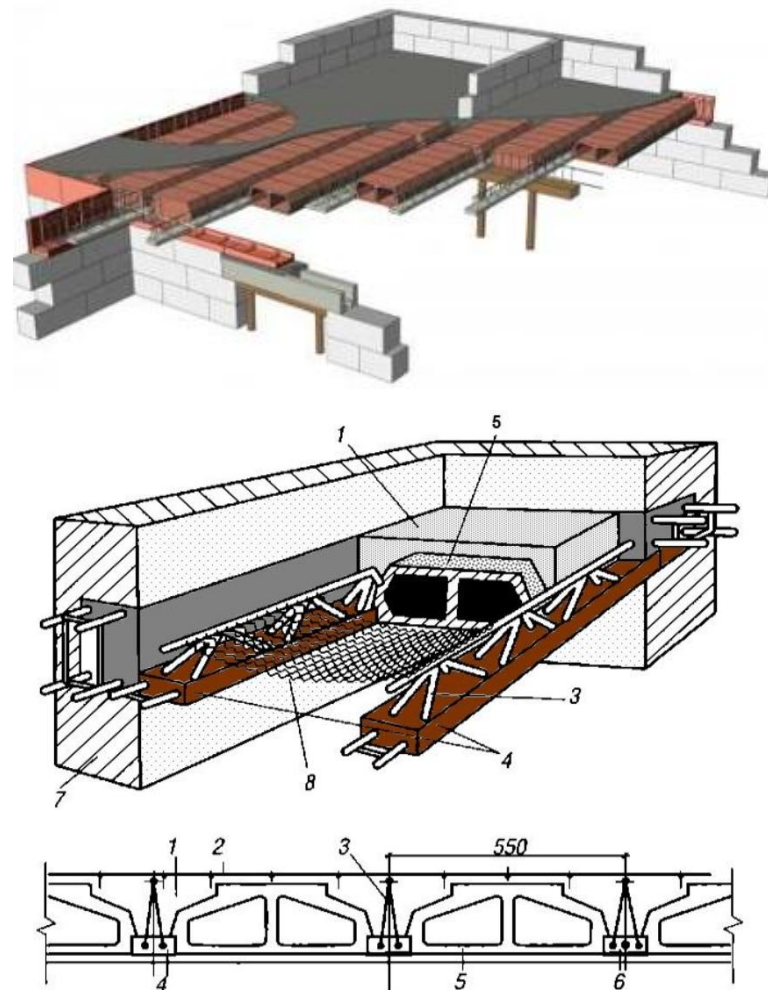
Фрагменти збірномонолітного перекриття із порожнистих бетонних та керамічних блоків: 1 – шар бетону, 2 – армуюча сітка, 3 – вільна арматура балки, 4 – монтажна залізобетонна балка, 5 – пустотілий блок, 6 – підсилена залізобетонна балка, 7 – арматура розподільчого армованого поясу, 8 – арматурна сітка [3]
